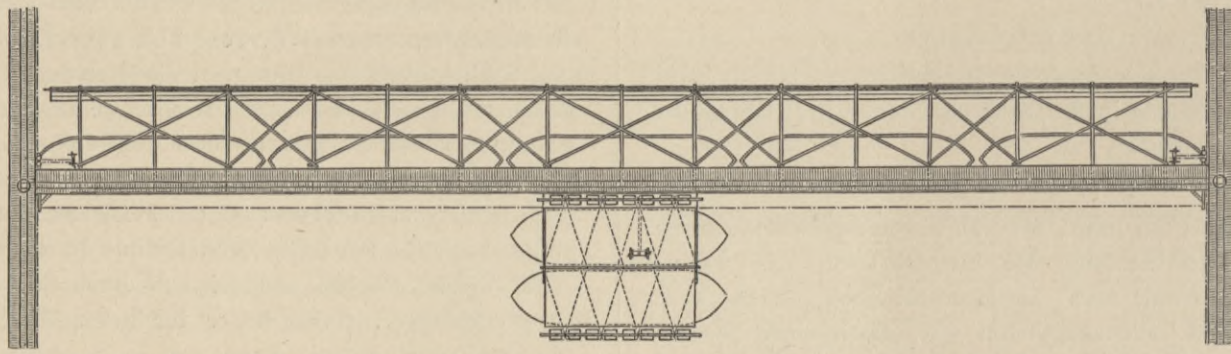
Grundriss der Schwimmbrücke, der anschließenden festen Förderbrücken und des Versenkgerüsts.
